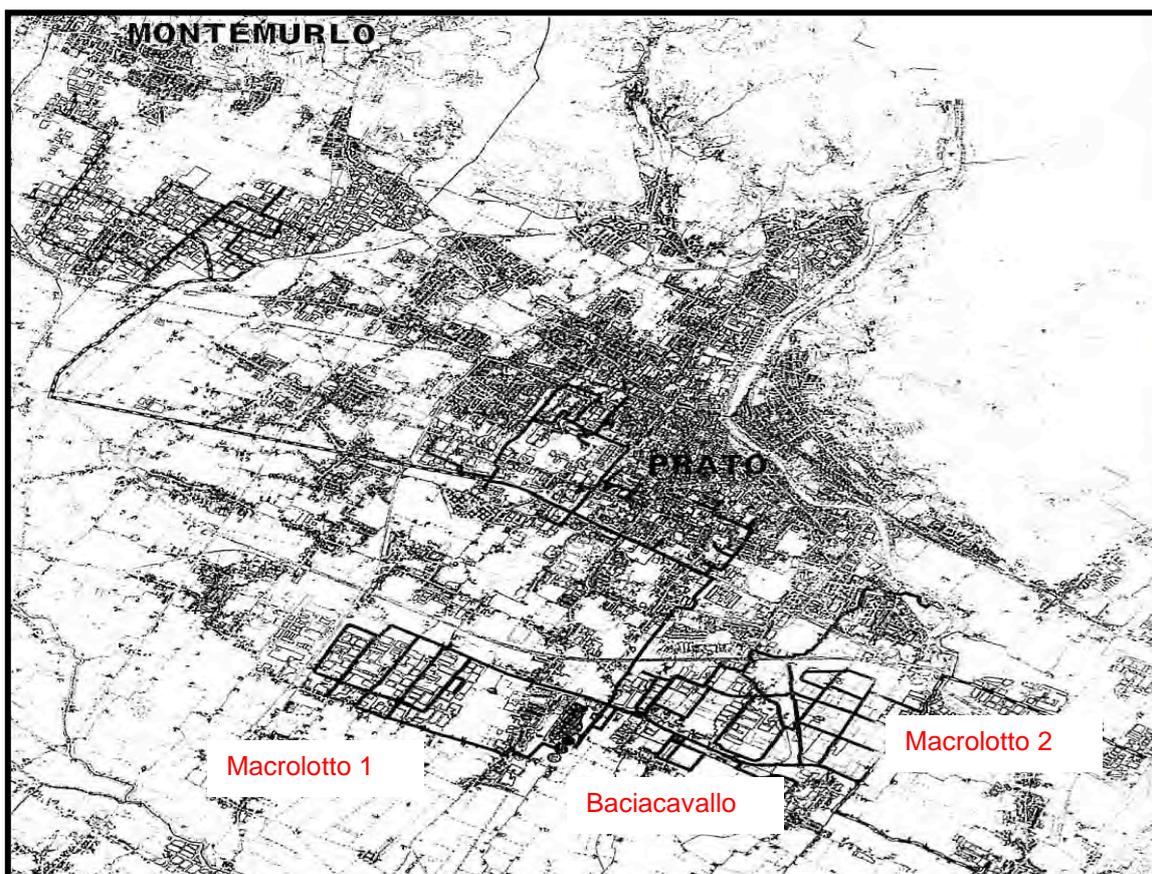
61 - Acquedotto industriale: planimetria generale
